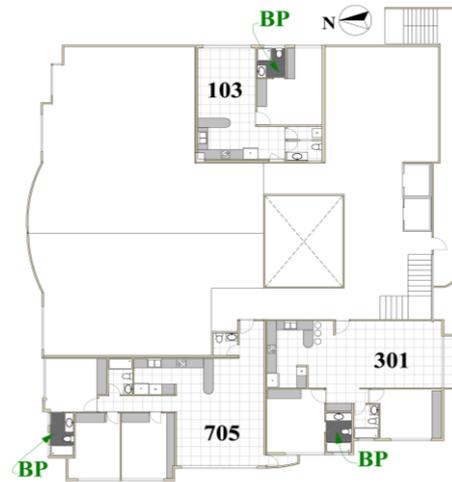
Estudio de los baños principales en la planta arquitectónica.
